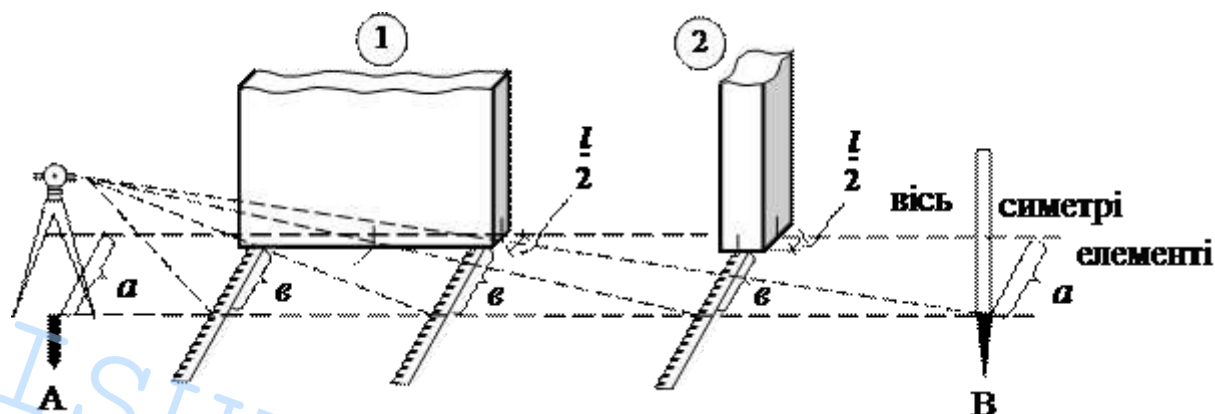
Схема способу бокового нівелювання: 1 – монтаж панелей; 2 – монтаж колони
